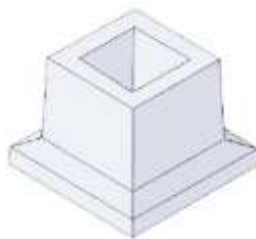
Фундаментний стакан типу СП із підошвою [4]
